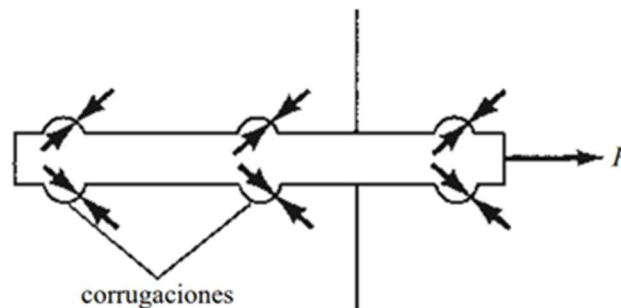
Transmisión de fuerzas entre corrugas de acero de refuerzo y concreto
